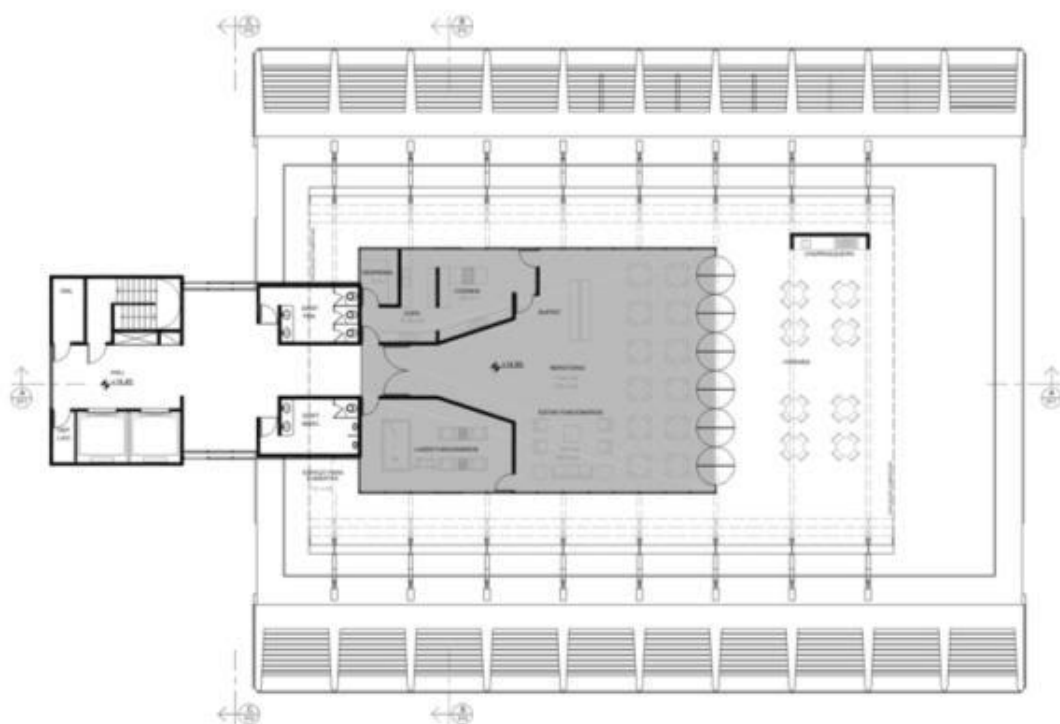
Planta Baixa | Cobertura. (FONTE: SKYSCRAPERS, 2011).
